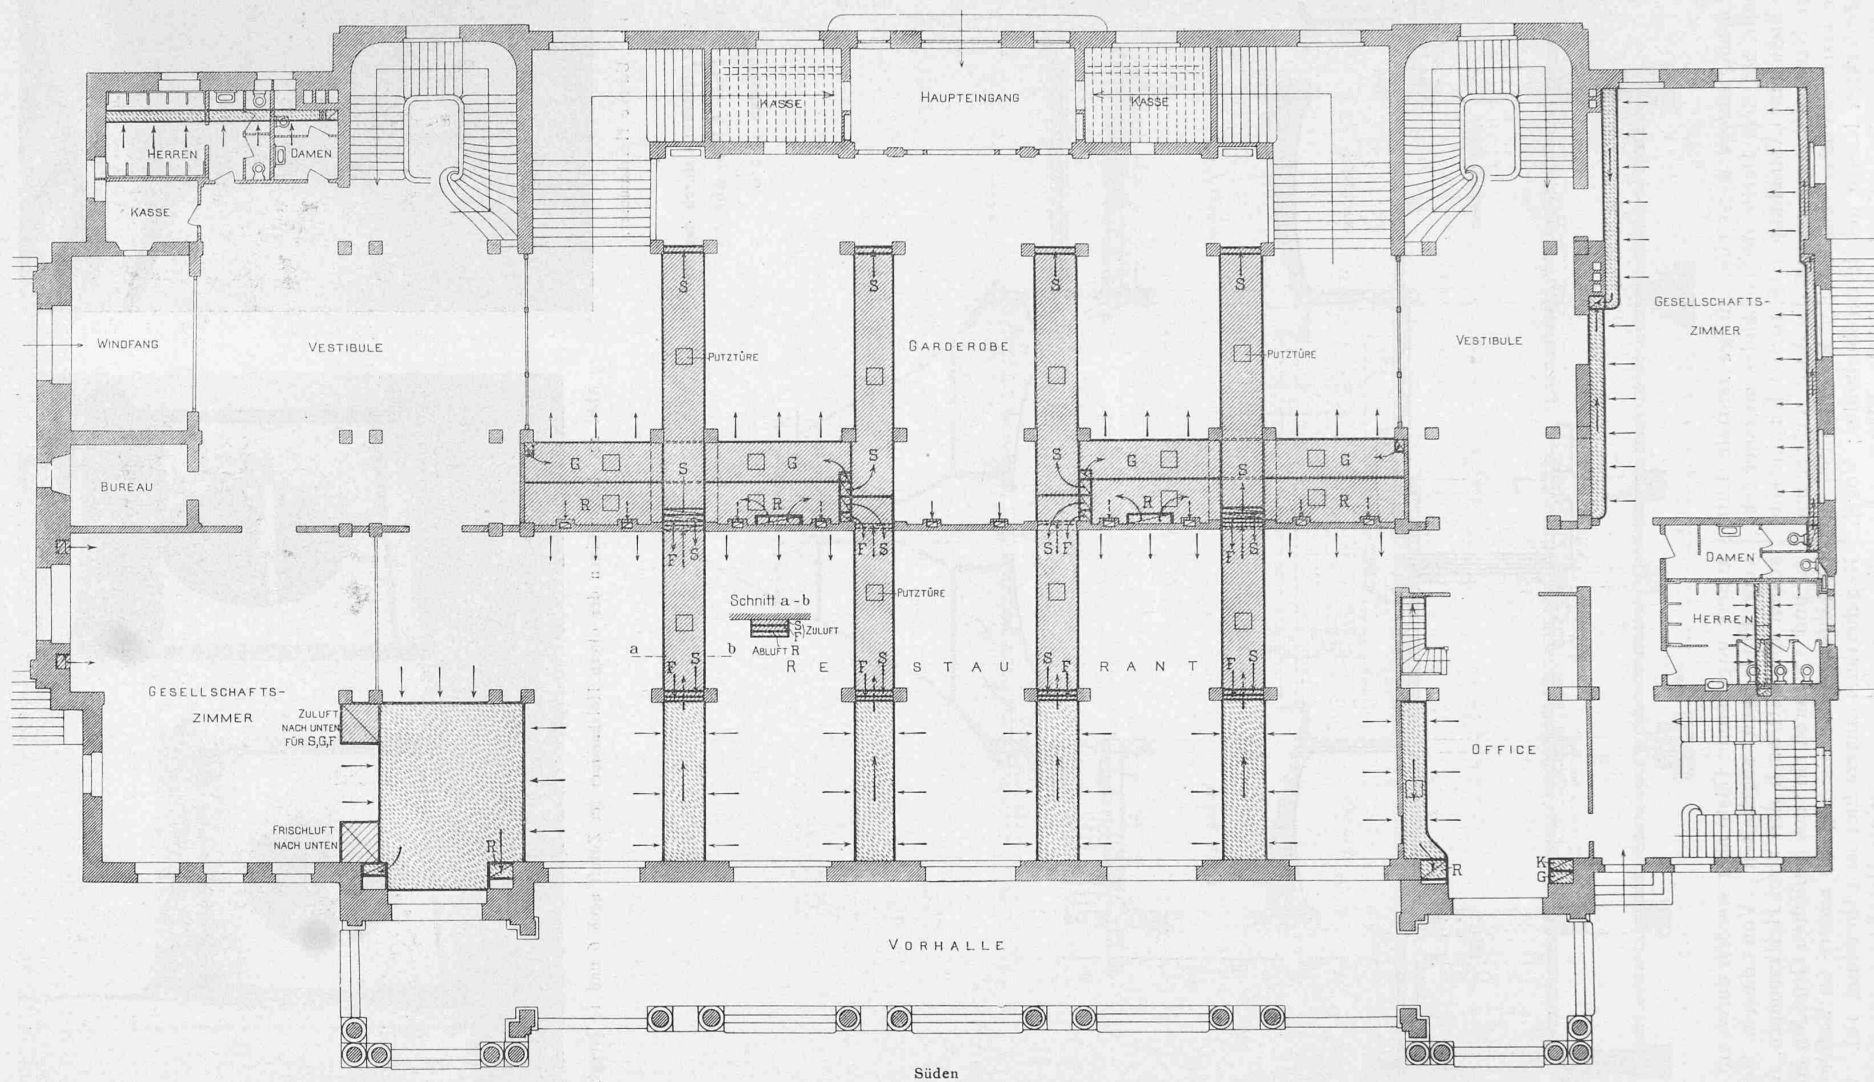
Grundriss vom Erdgeschoss mit den an dessen Decke geführten Lüftungskanälen. — Masstab 1:250.
